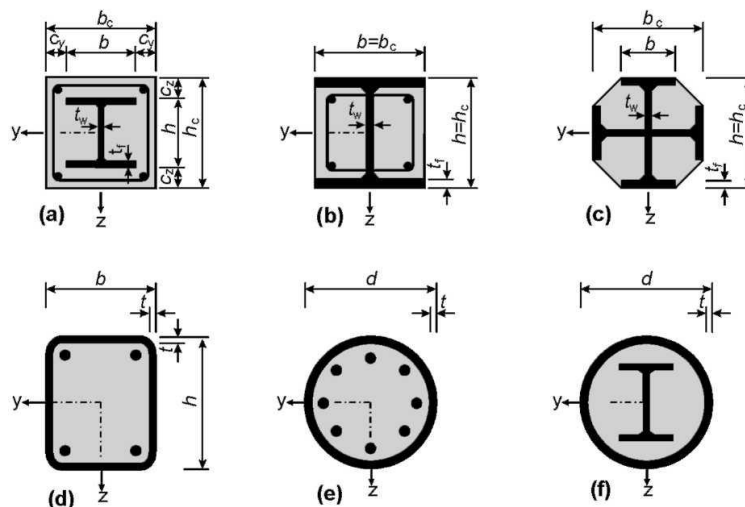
Типові поперечні перерізи сталезалізобетонних стійок з позначеннями
